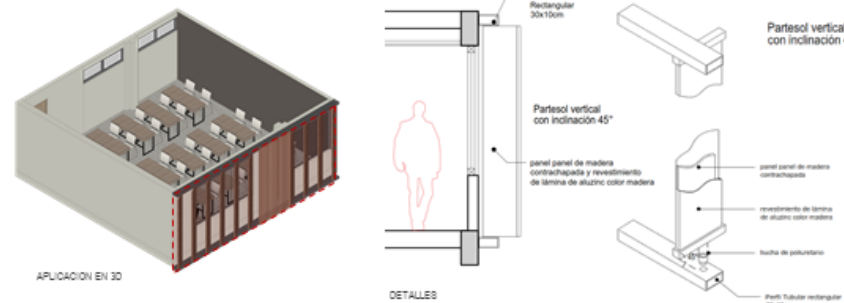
Vista 3d, detalles de elementos de protección aplicados en el aula seleccionado.
